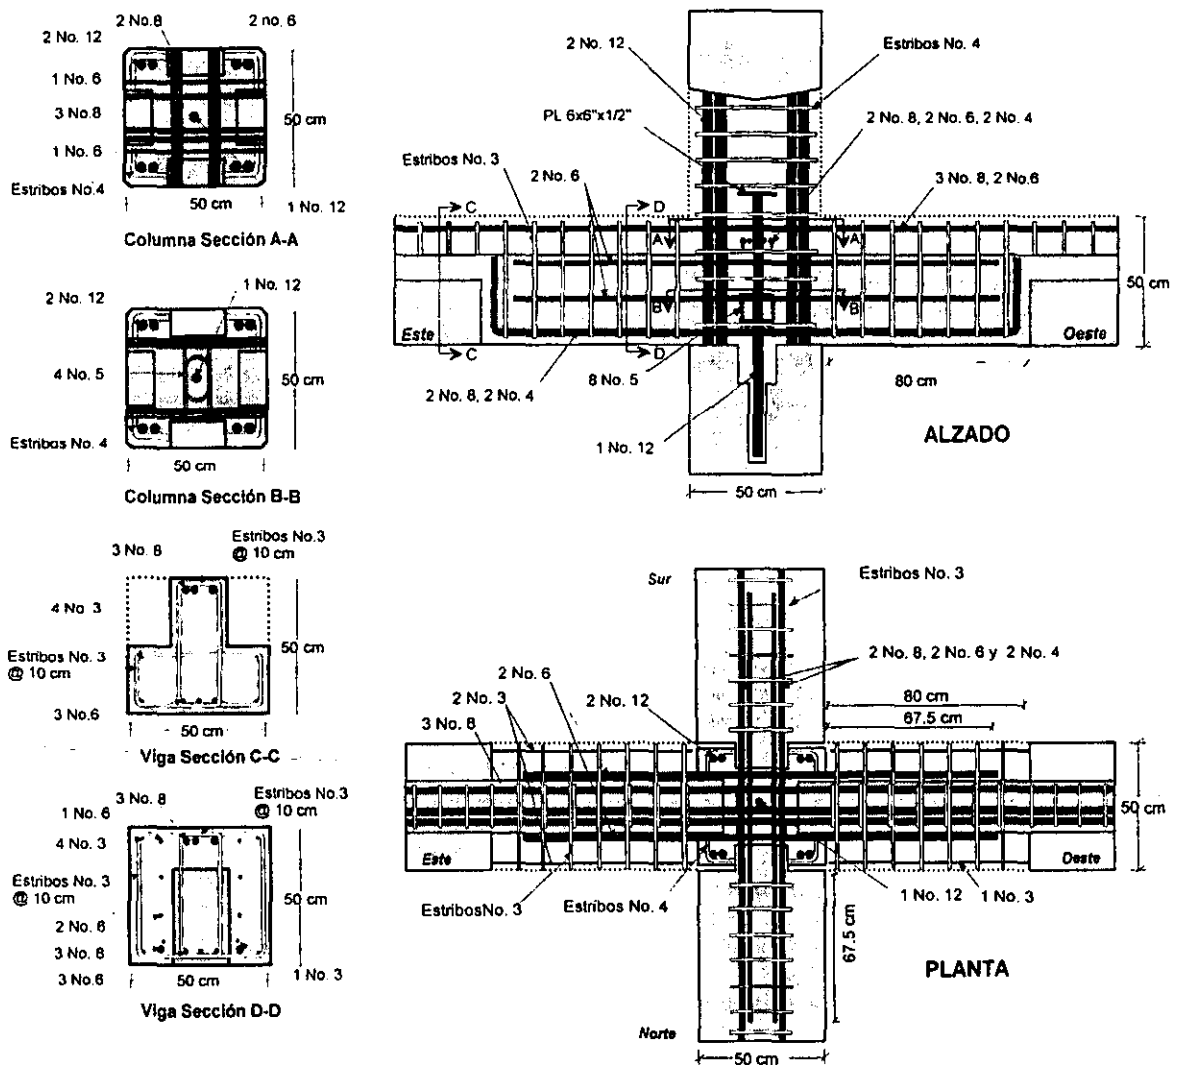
Detalles de la unión viga columna, dirección portante
